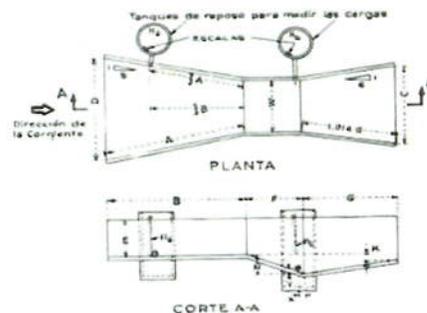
Planta, elevación y dimensiones de un medidor Parshall
